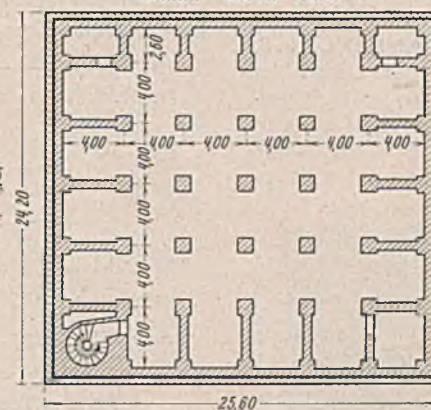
Querschnitt und Grundrisse des fertigen Bauwerks.
